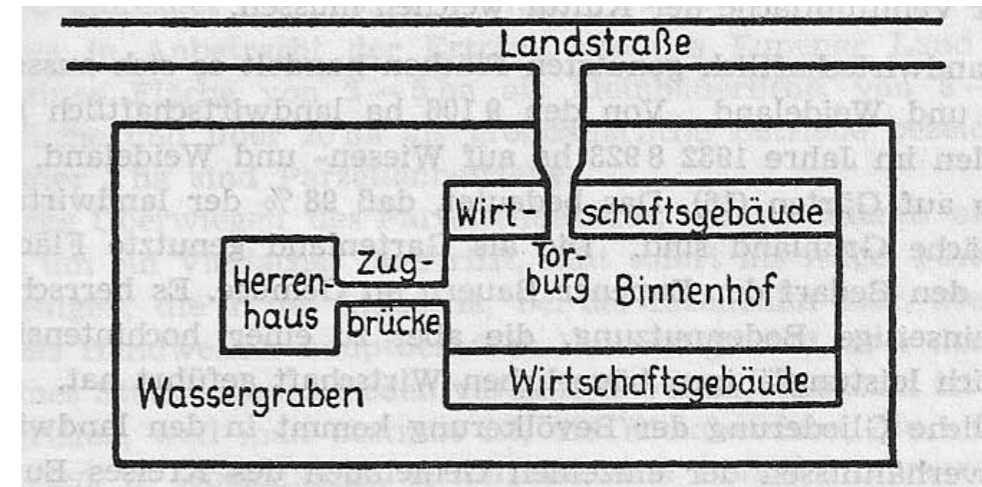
Grundriß einer Wasserburg (L. Timmermann).
